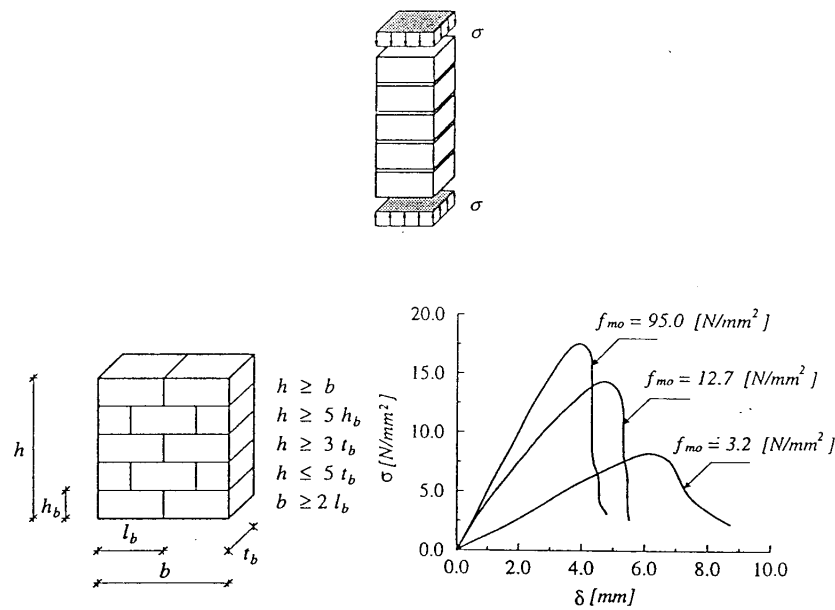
Comportamiento uniaxial de la mampostería bajo carga normal al plano de las juntas horizontales
